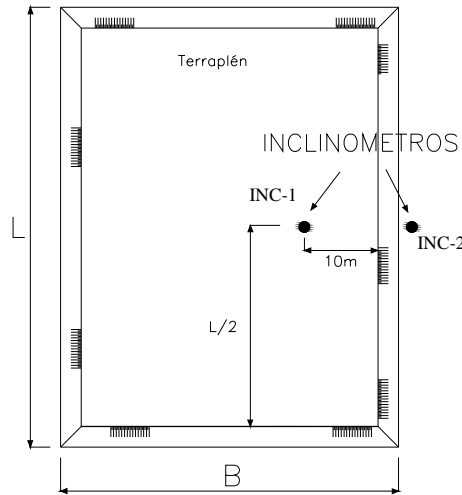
Propuesta de ubicación en planta de los inclinómetros (INC-1, INC-2) para los terraplenes de prueba TR-1 y TR-2
